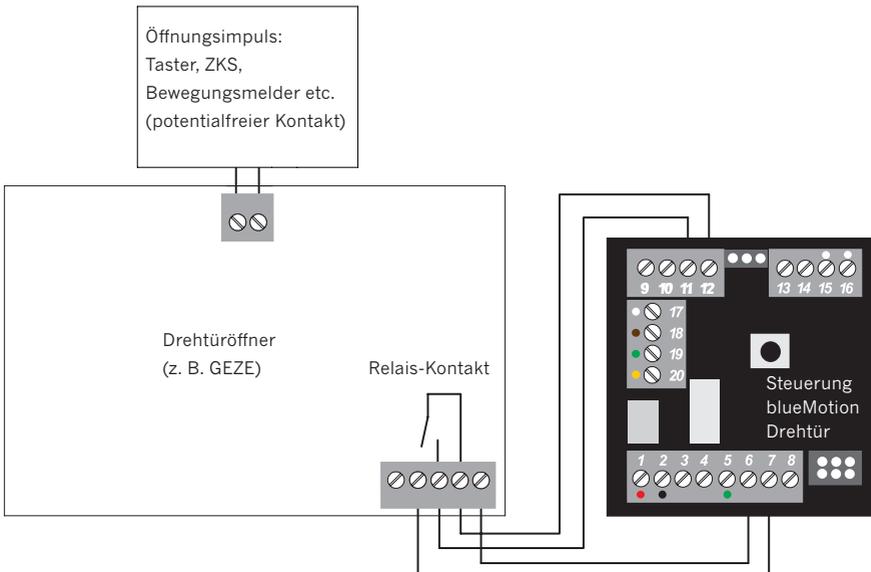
Allgemeiner Verdrahtungsplan blueMotion mit Ansteuerung Drehtür-Antrieb
